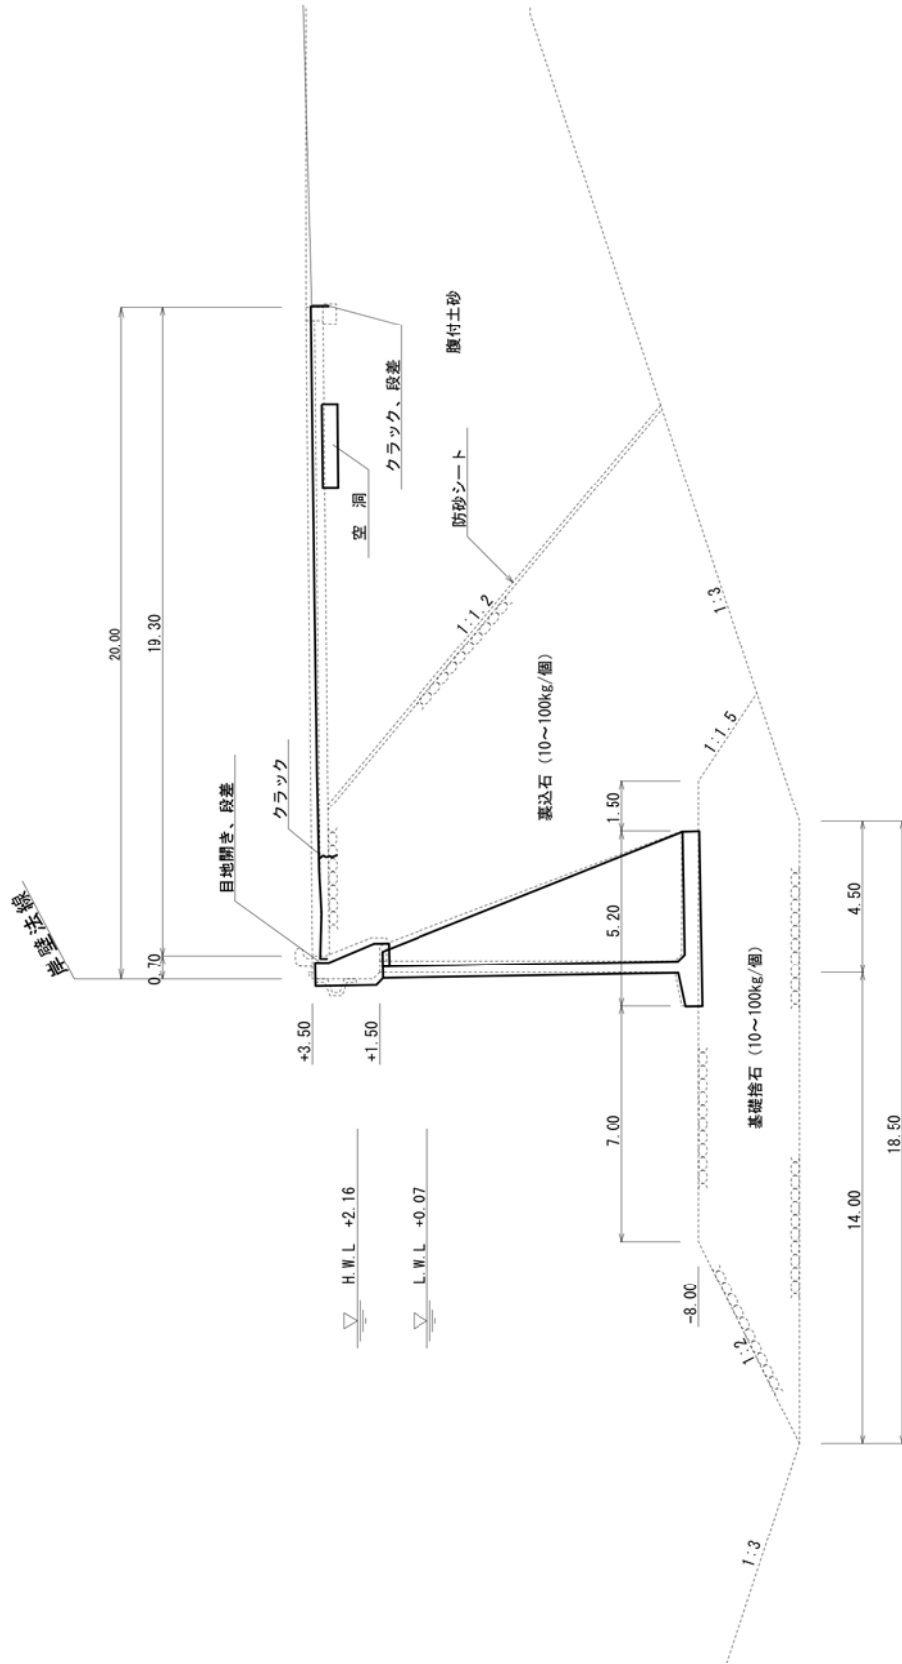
香椎パークポート地区北-7.5m岸壁の被災状況断面図
